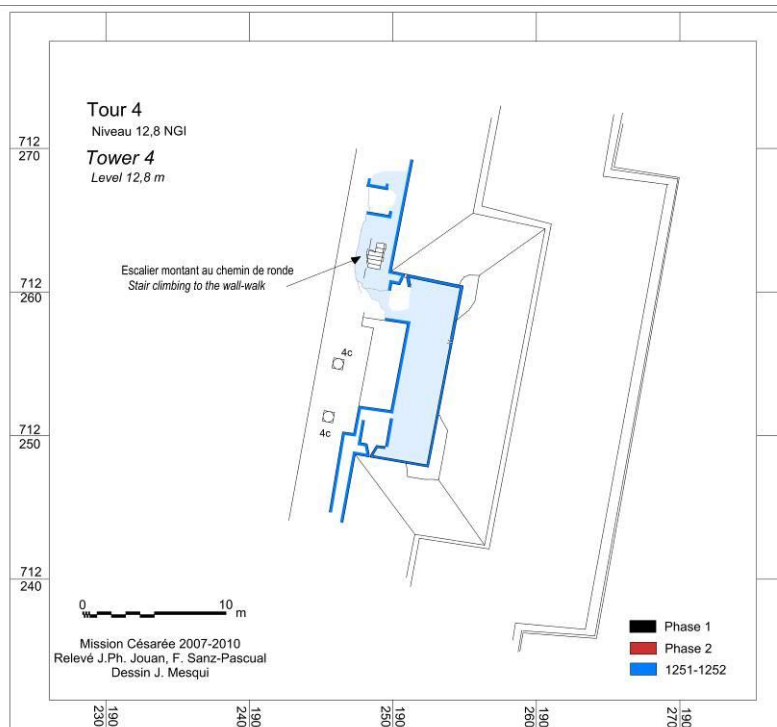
Plan de la tour T4 au niveau 12,8 m ASL
